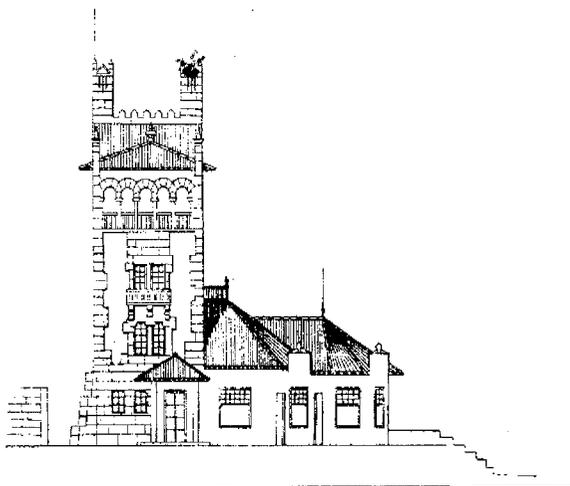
Proyecto de Restaurante del Monte Santa Tegra (A Guarda). Alzado fachada lateral, Antonio Palacios. (Revista Nacional de Arquitectura)
